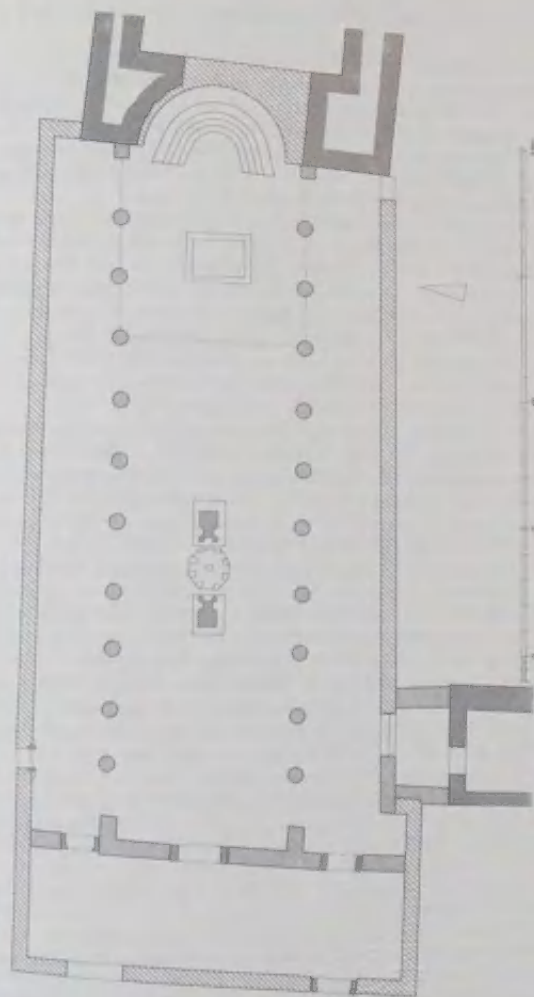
Säulenbasilika 2, rekonstruierter Grundriss. M 1:250
